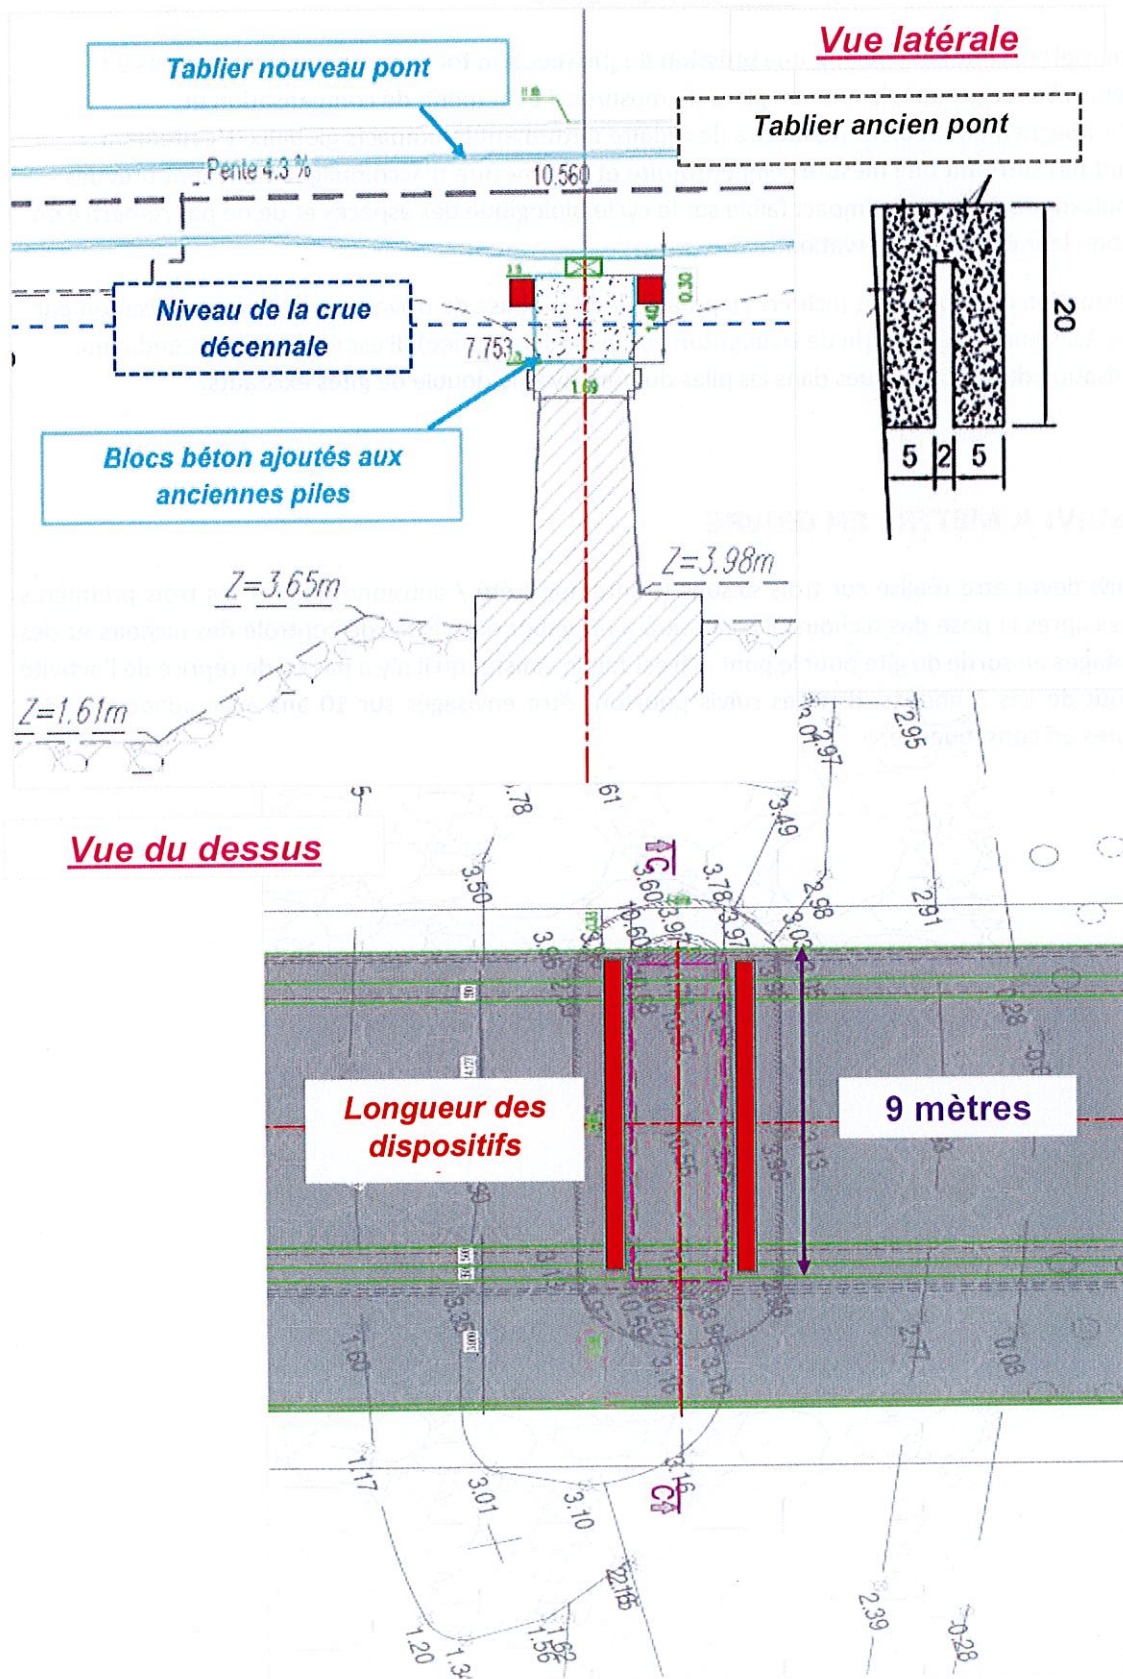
Schéma d'implantation de principe de gîtes à chiroptères à installer après les travaux sur les piles du pont
